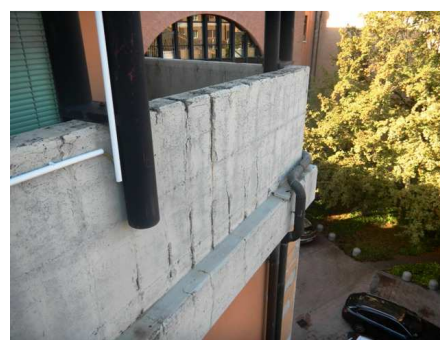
degrado del muro di parapetto delle sopraelevazioni dei corpi C e D
